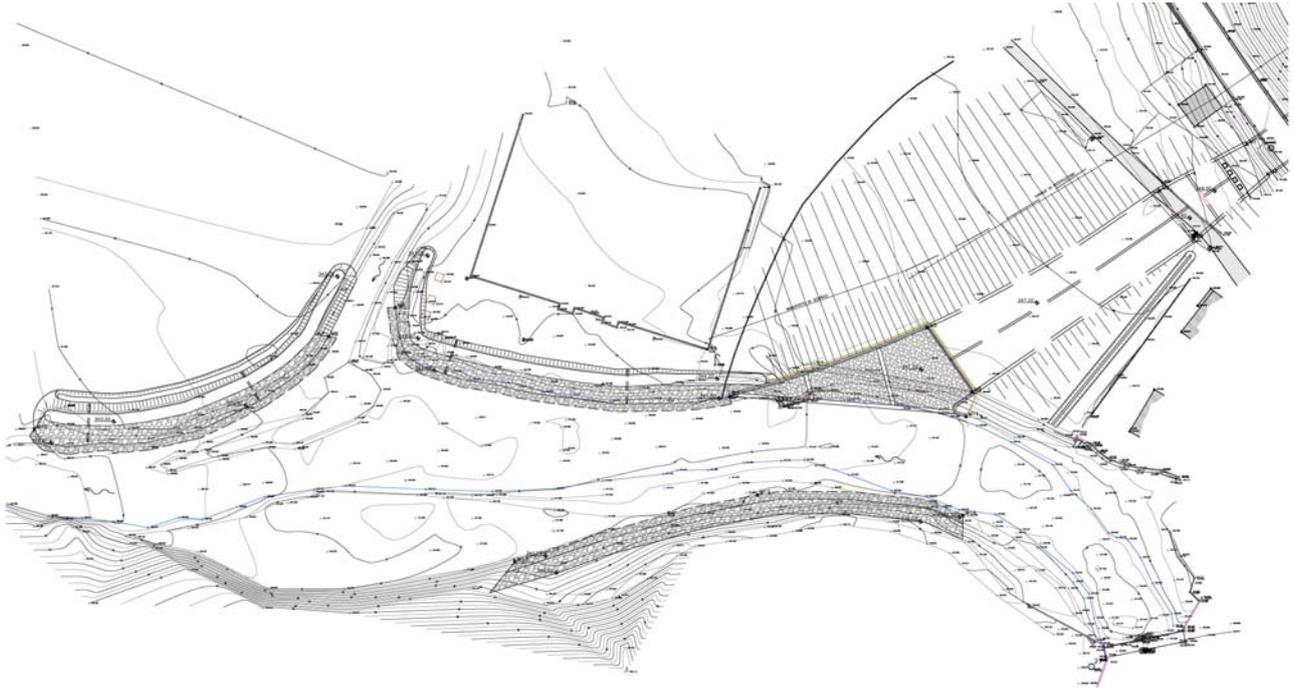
planimetri opere di restituzione e di protezione confluenza galleria di by-pass / Chiese
